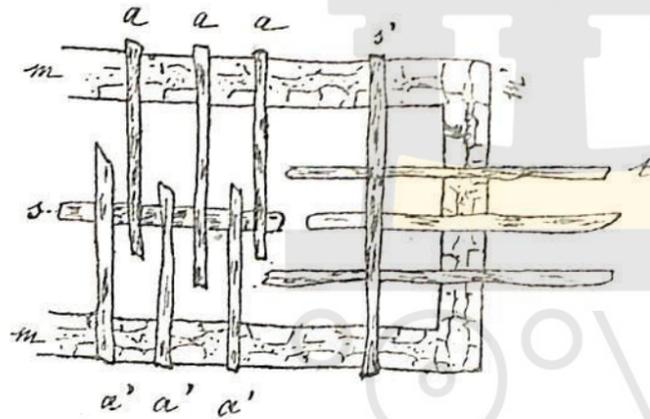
Coupe transversale des murs d'une maison au niveau du premier étage.
